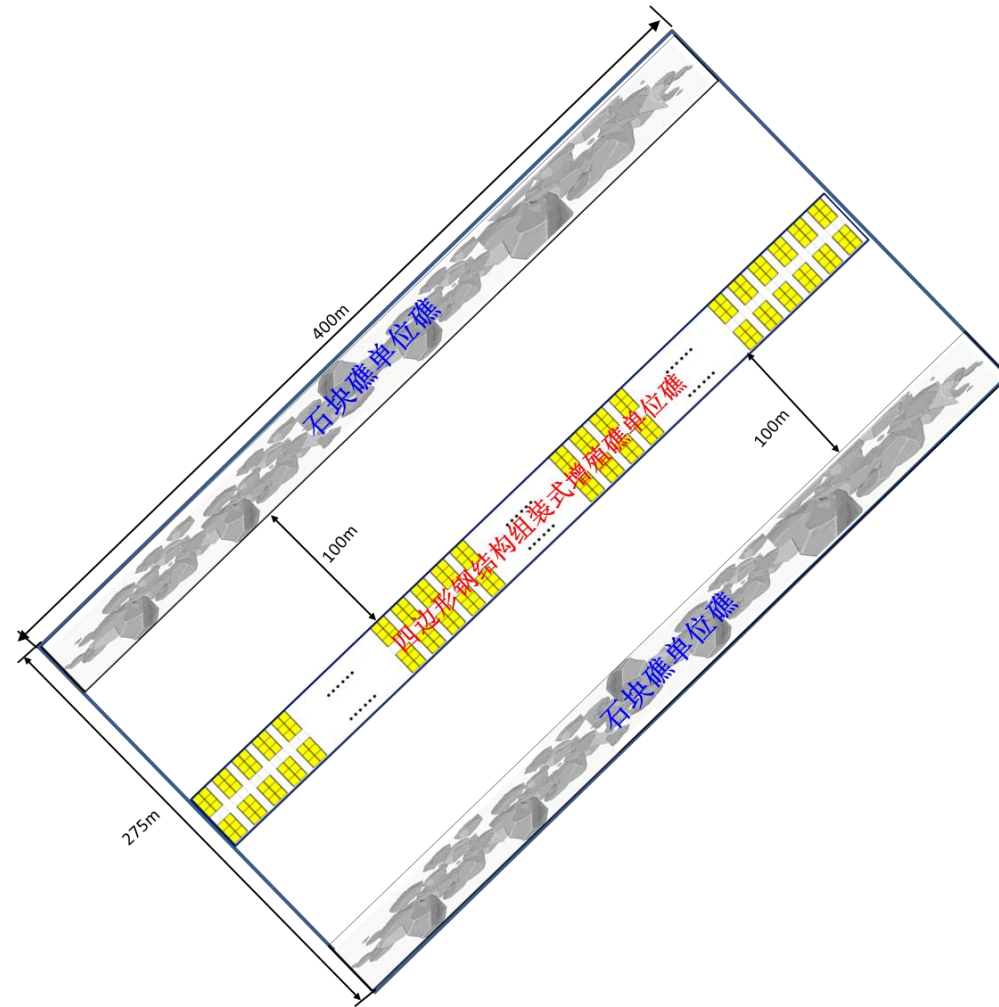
鱼礁群内单位礁平面布局示意图
